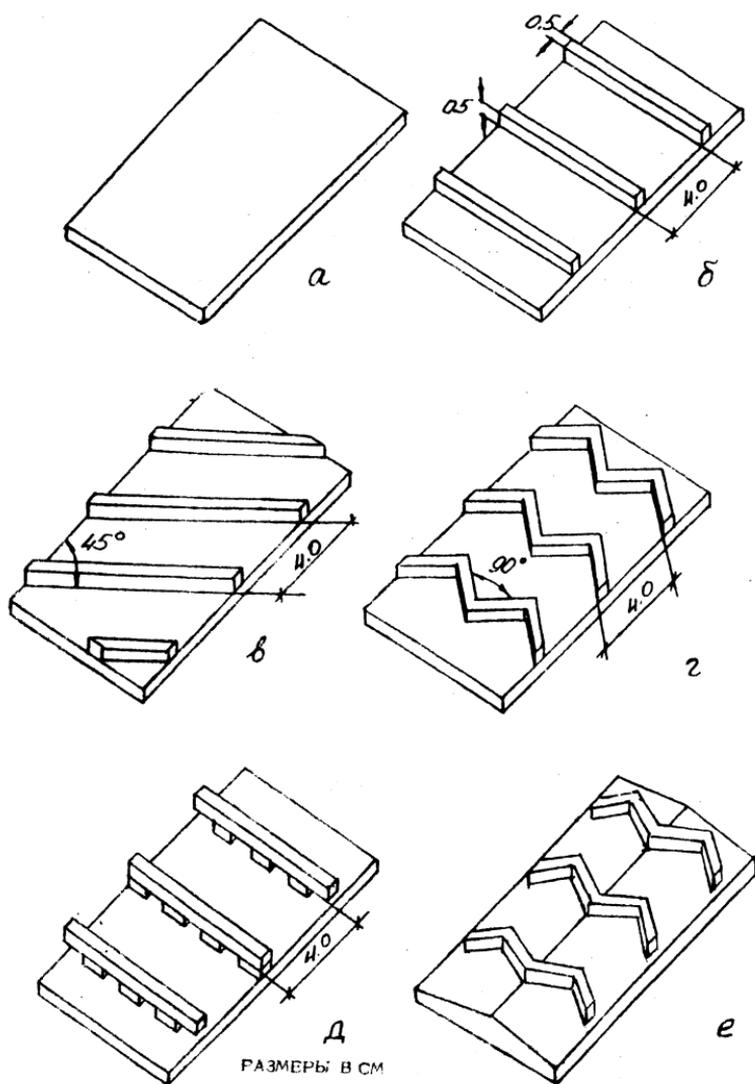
Рис. I. Типы плит покрытия и карнизных элементов: а - гладкие
